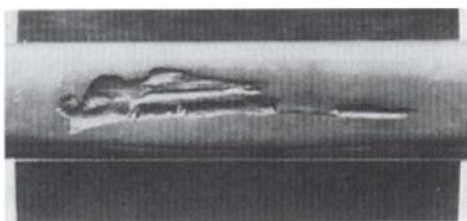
Fissuração horizontal na mesa de rolamento (Fonte: V. A. Profillidis)
